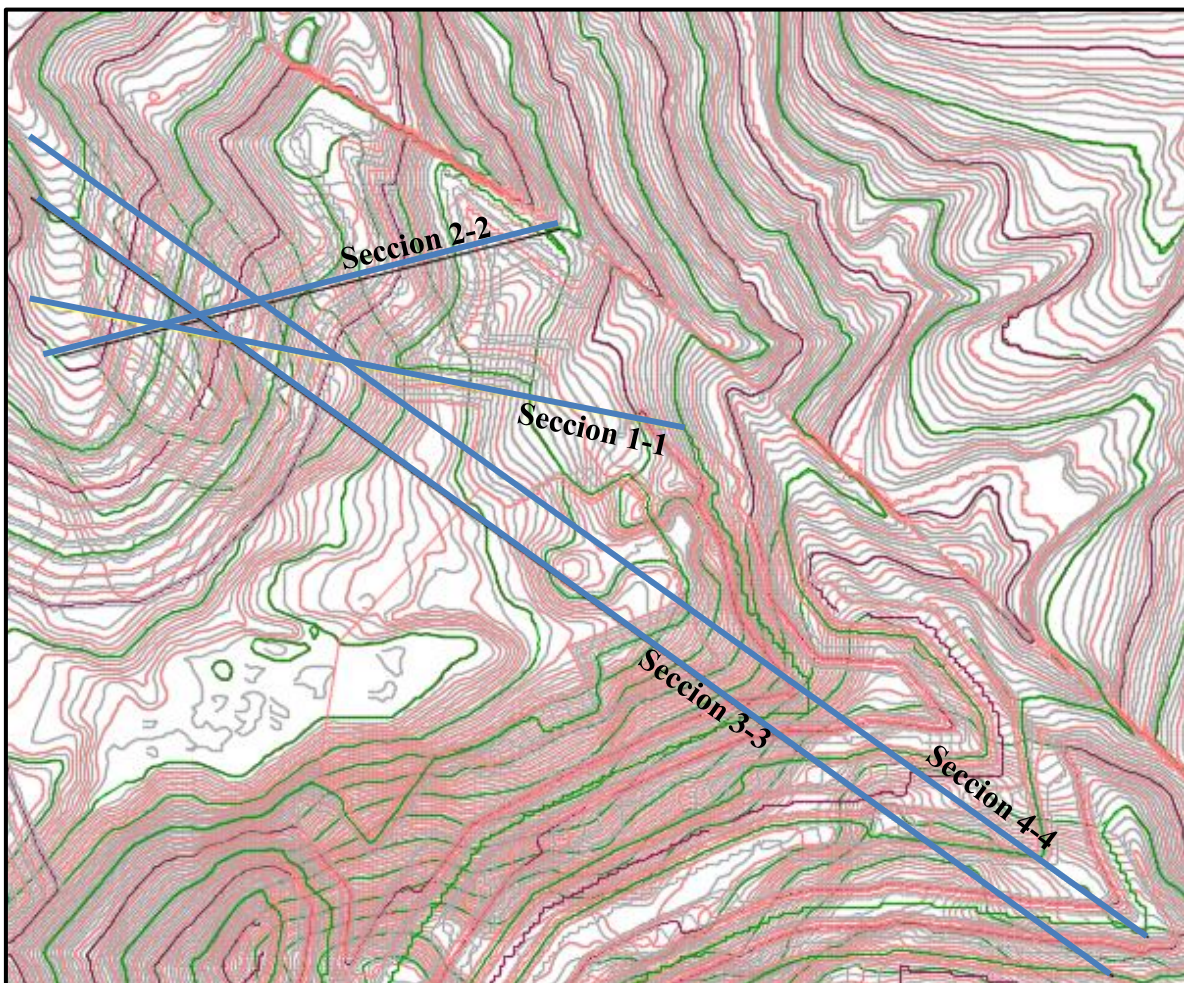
Localización en planta de las secciones analizadas para el quinto año.
